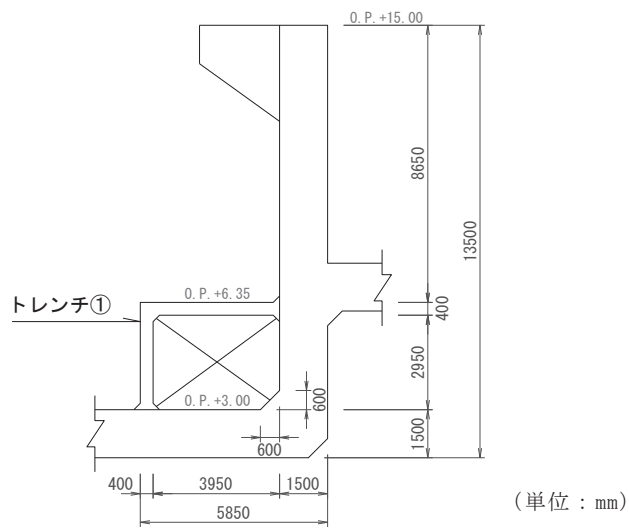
(7) 補機ポンプエリア断面図 (⑦—⑦断面)
